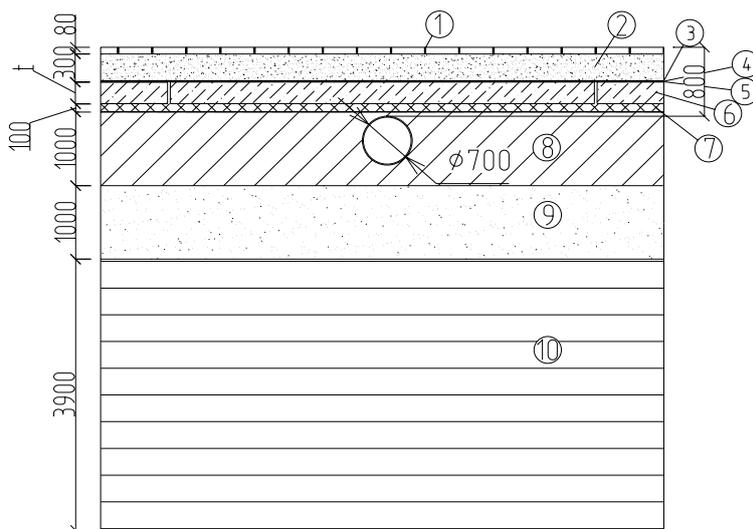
Рассматриваемая конструкция пола каре: 1 – тротуарная плитка; 2 – песчаная отсыпка; 3 и 5 – геотекстиль; 4 – бентонитовые маты; 6 – бетонное основание; 7 – теплоизоляционный слой; 8 – сунесь; 9 – песок; 10 – водонасыщенная глина.
